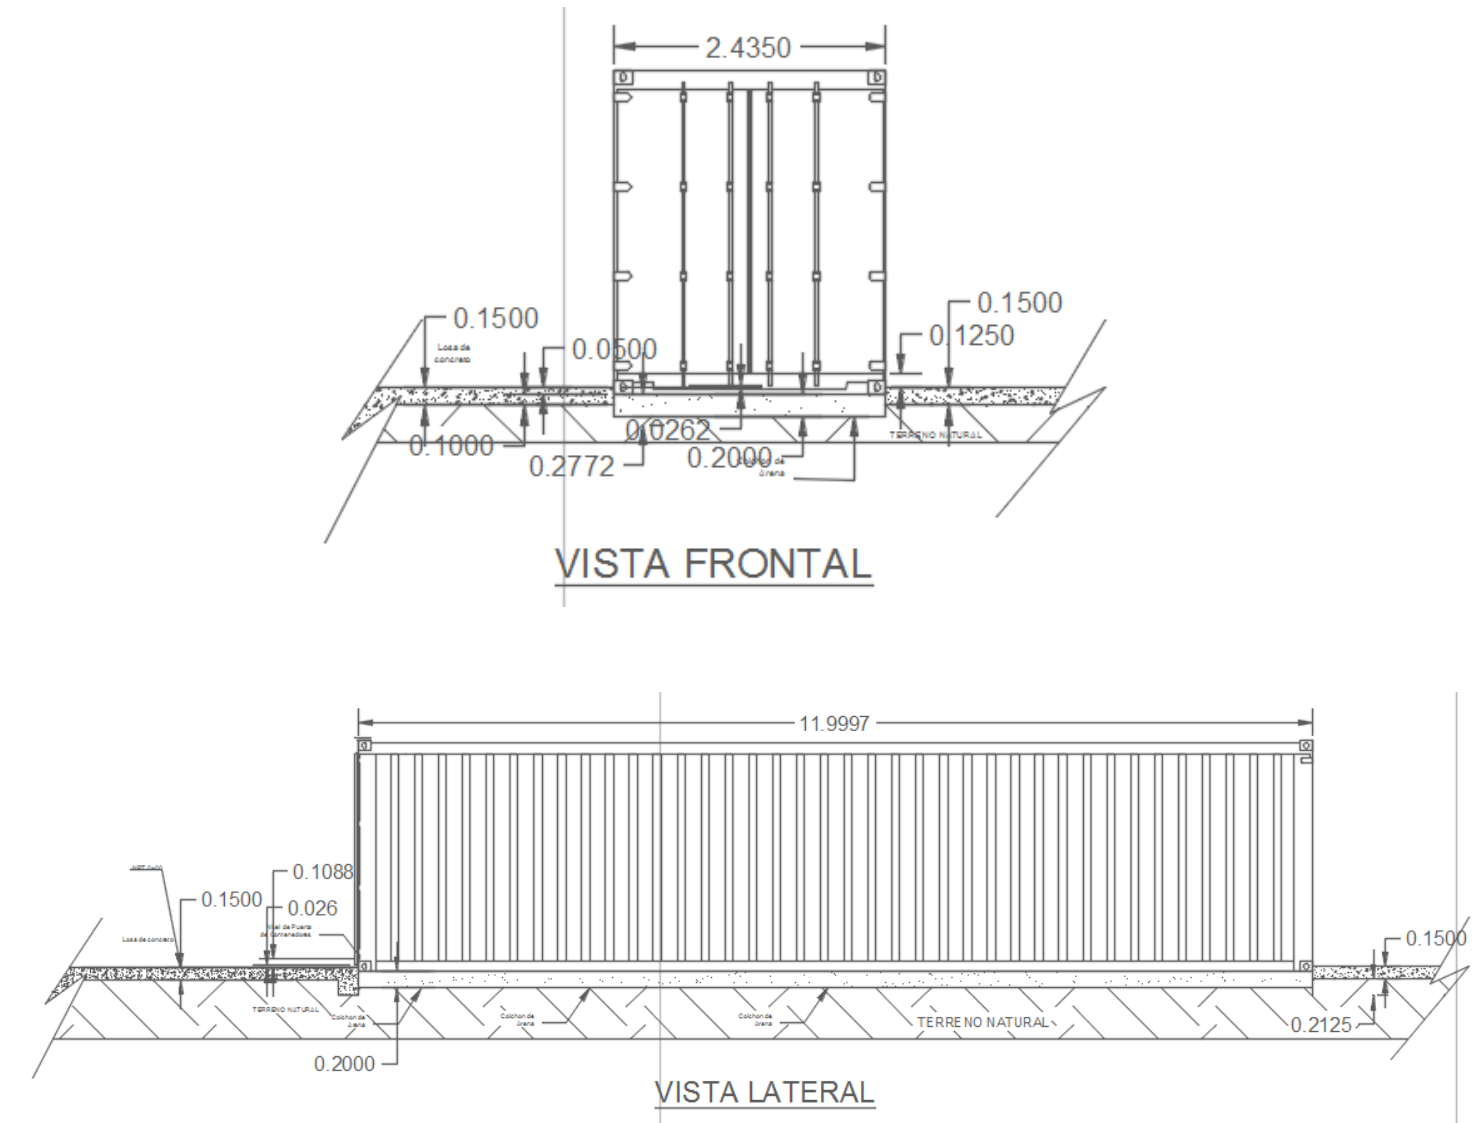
Detalle de colchón de arena en contenedor.
